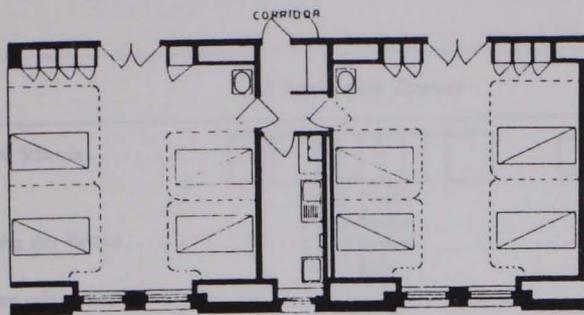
Grundrißausschnitt aus dem semi-private Pavillon im Mt.-Sinai-Hospital, New York City. Arch. Robert D. Kohn und Charles Butler
